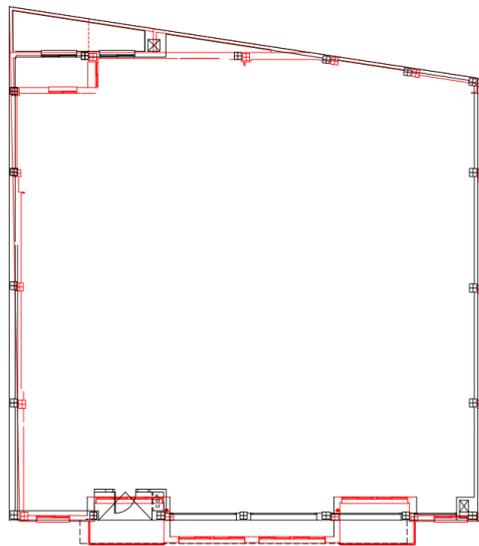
Superposición de envolvente de Planta Baja y Planta Tipo, 2014.
